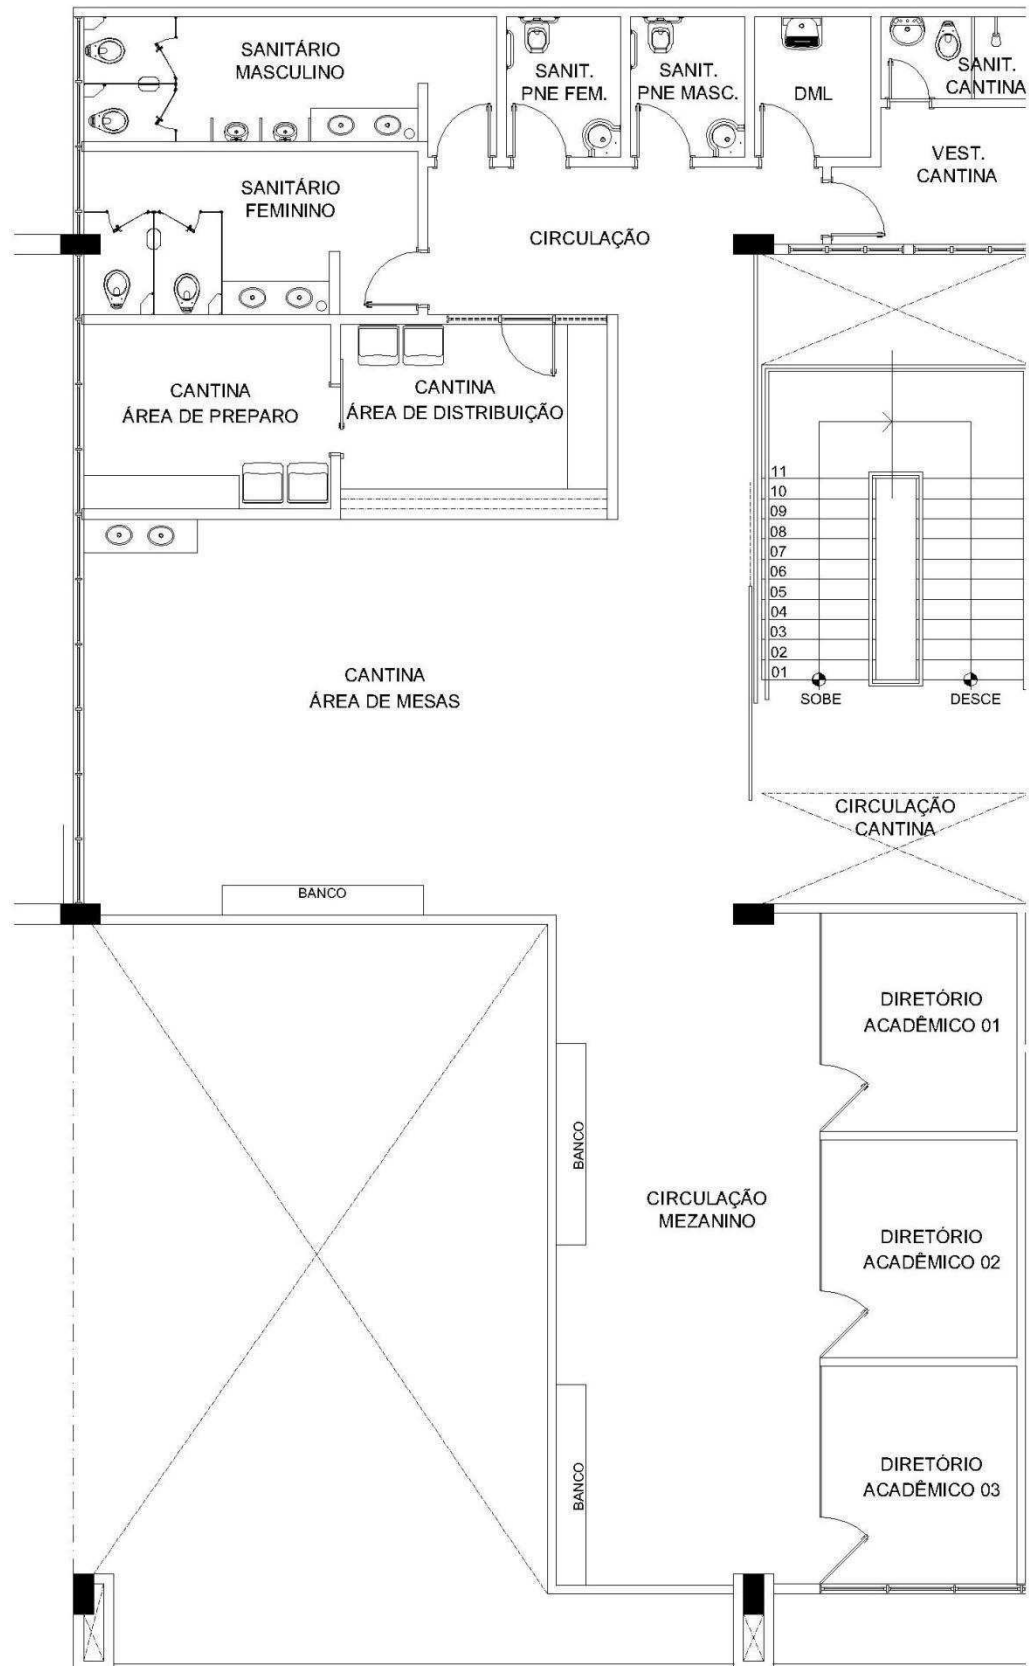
Planta parcial do 2º pavimento do ICS – Cantina, Mezanino, DCE
